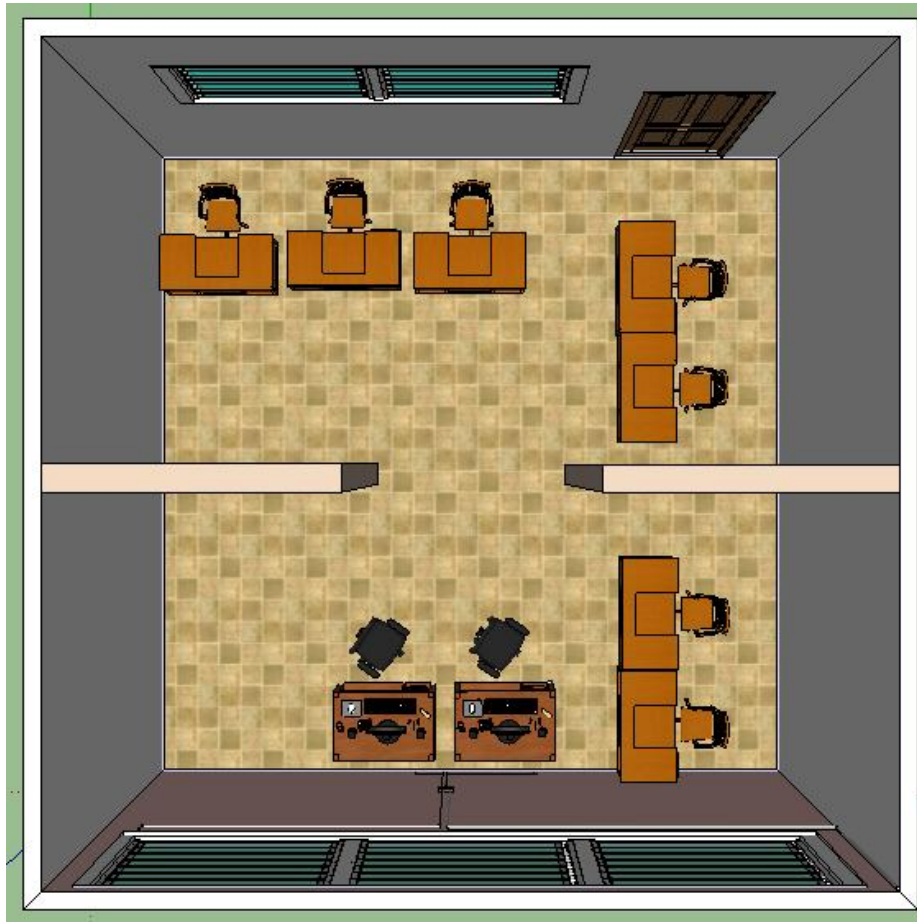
L: Vista en planta de la Sala de Maestros
